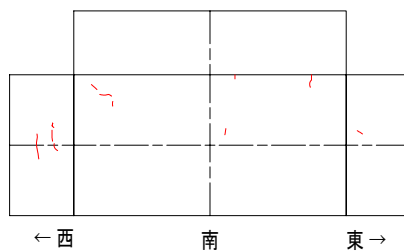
model-a(配合 No. 3)のひび割れ状況
